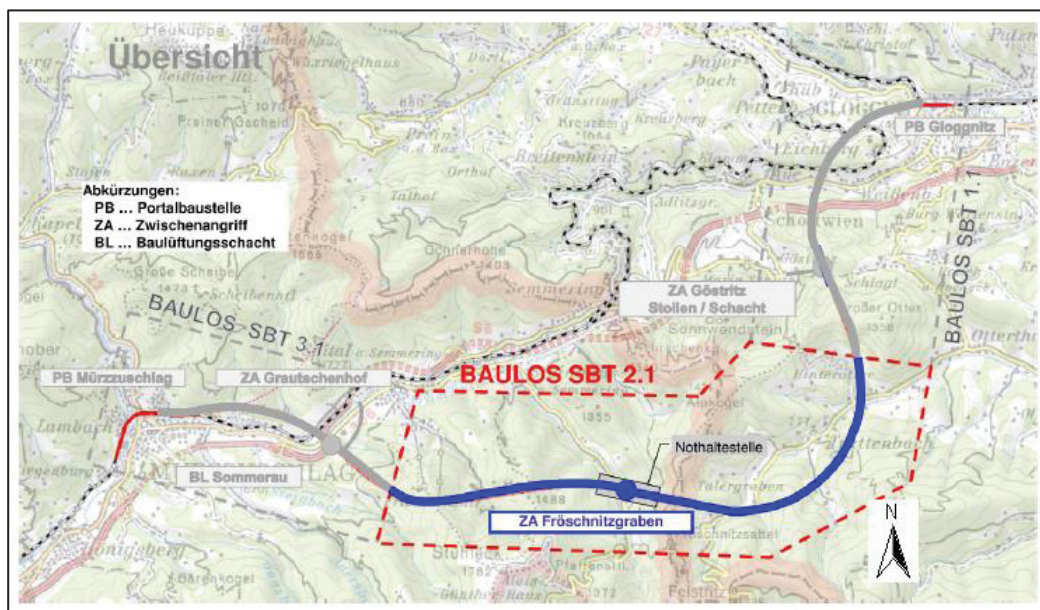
Übersichtslageplan Baulos SBT2.1 - Tunnel Fröschnitzgraben (aus [26])
